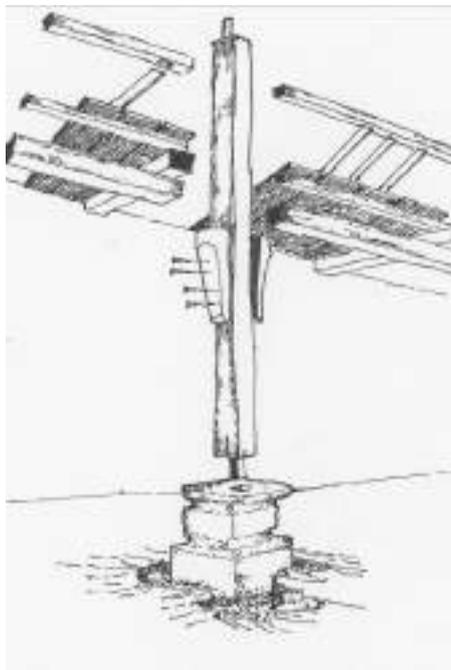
Cañar, Honorato Vázquez. Sistema de ensamblaje y reforzamiento de áreas de apoyo con diseño en piedra basa en portal exterior.
